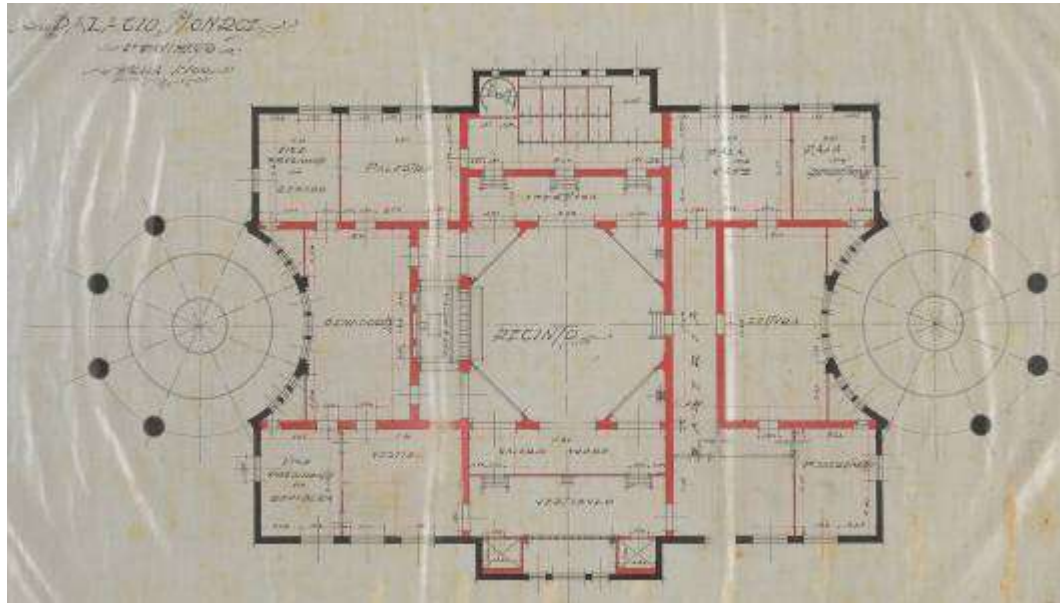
2º Pavimento (Fonte: Arquivo Nacional).
